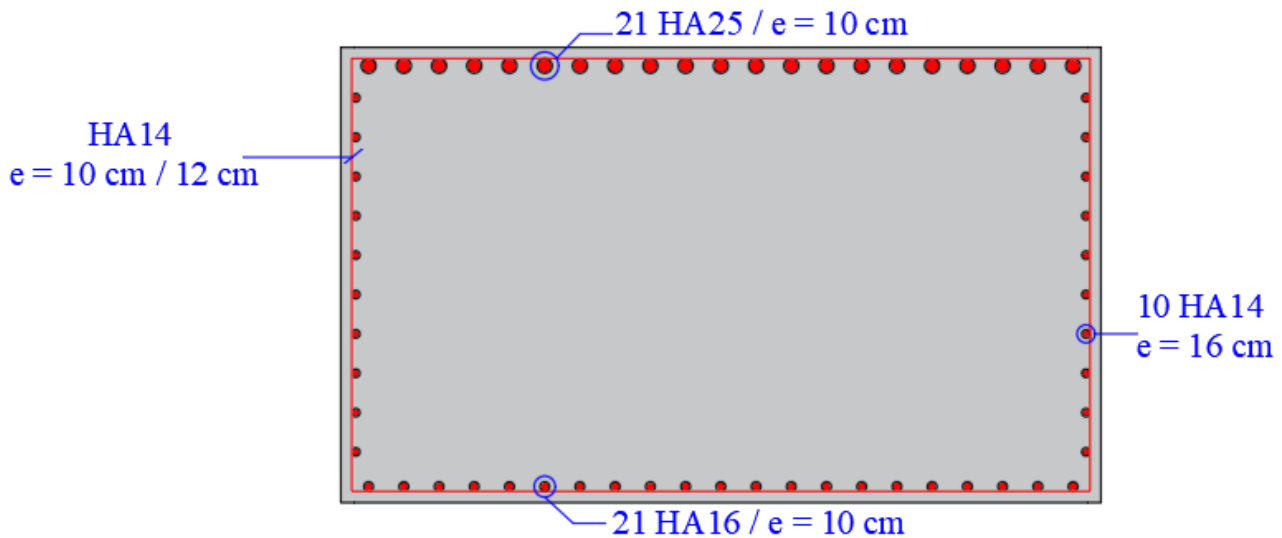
Ferrailage du chevêtre (COUPE TRANSVERSALE).
